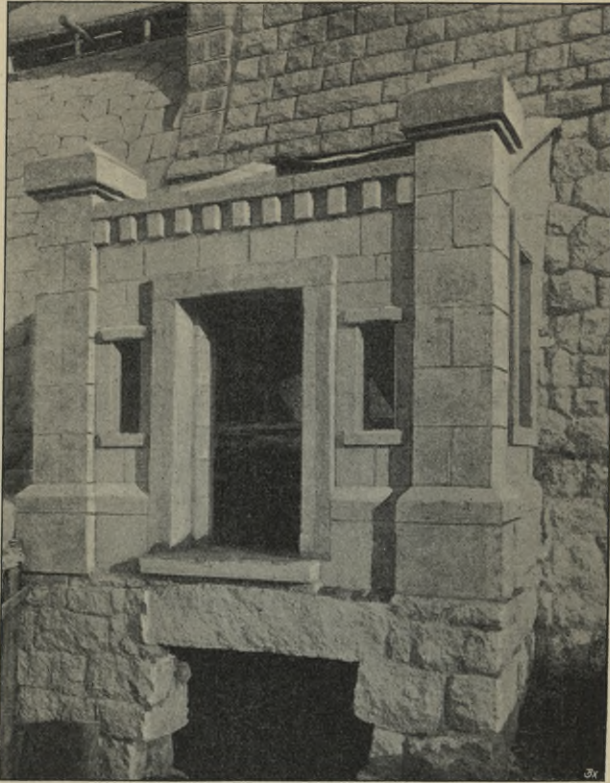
Schieberhaus der Voigtsbachsperre bei Reichenberg.
